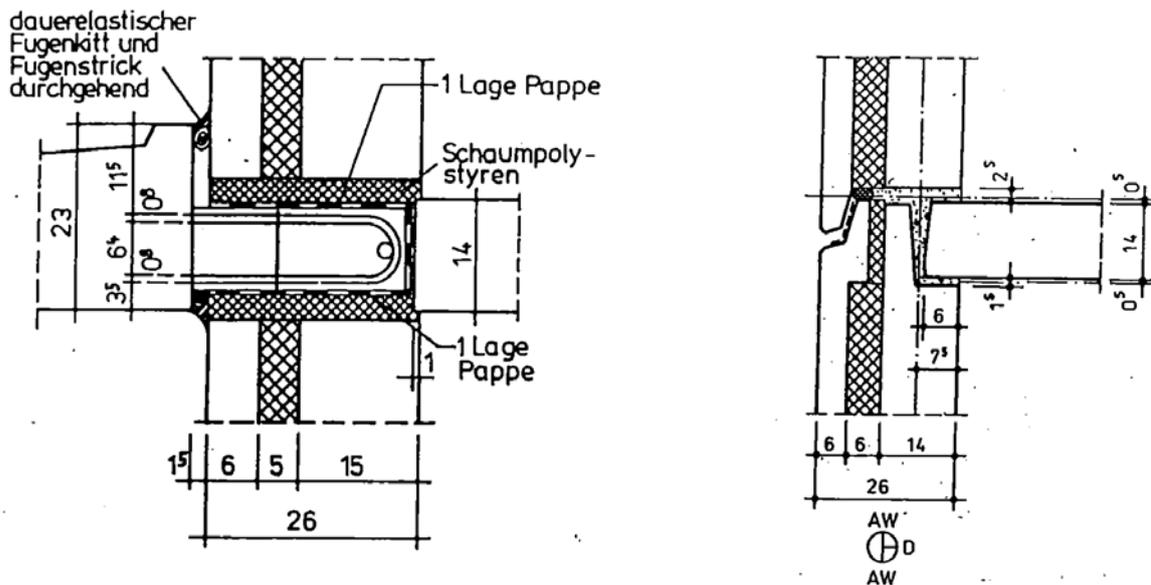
Detail Anschluss Loggia/Außenwand/Trenndecke PH05-06
